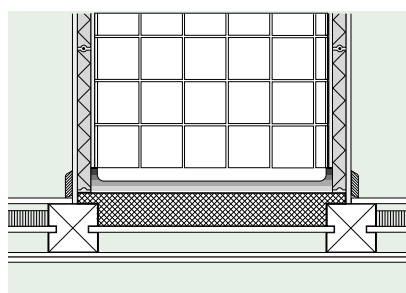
Eksempel på vådrum med betondæk udstøbt mellem træbjælker.
